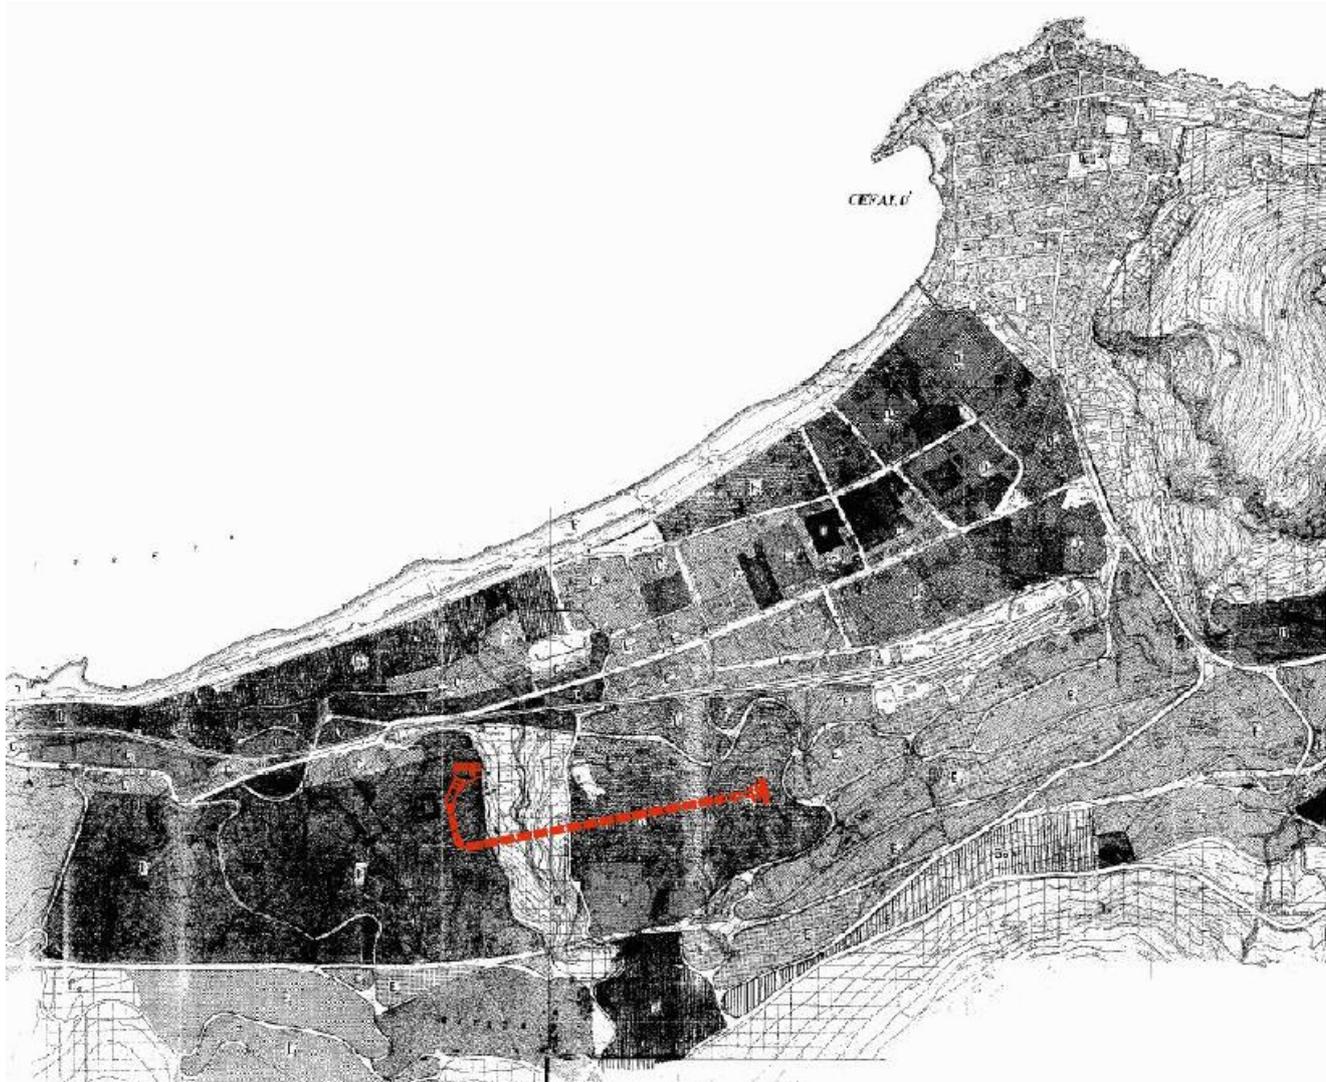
Sovrapposizione dello stralcio di PRG vigente con il progetto in oggetto
